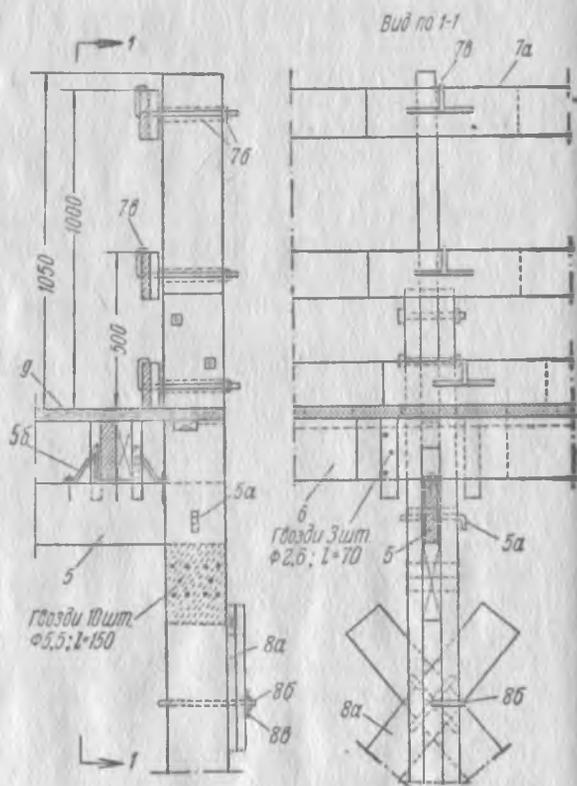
Инвентарные леса Гипрооргстроя для каменной кладки. Деталь конструкции перил
